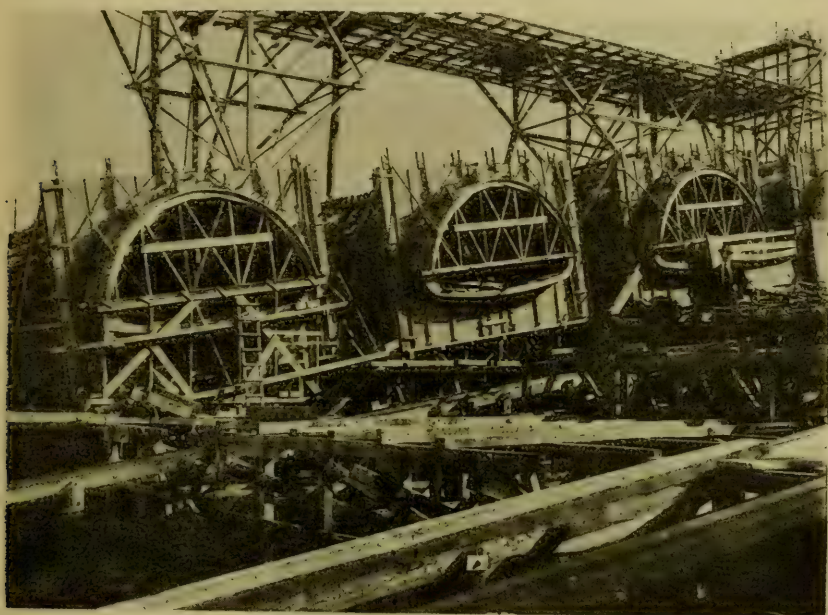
Sección subfluvial. Detalle de los encofrados de los conductos
